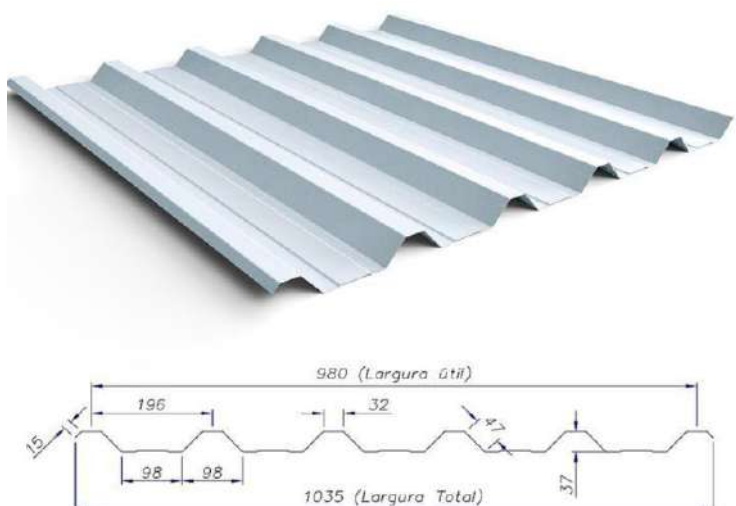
Imagem ilustrativa de telha metálica trapezoidal TP40-980.
